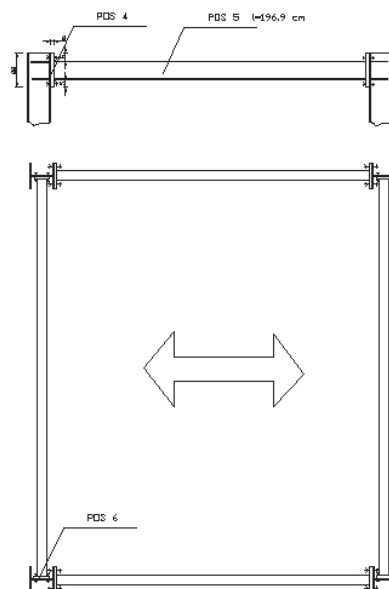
Versuchsaufbau – Konstruktion des Stahlrahmens, Aufsicht
